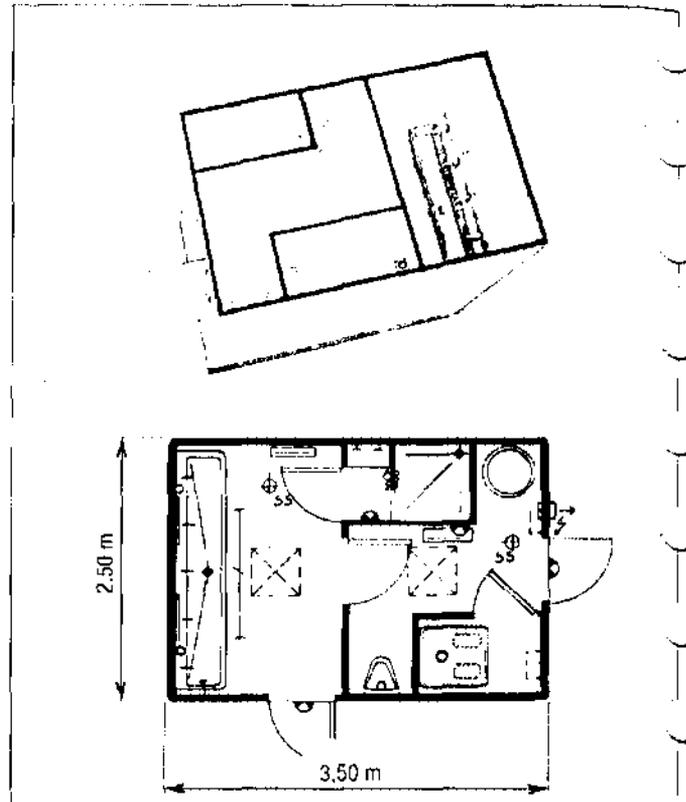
Modules sanitaires de chantier tout en panneaux sandwich en polyester armé de fibres de verre, totalement moulés intérieurement et extérieurement (1 douche, 1 WC, 1 urinoir, 5 points d'eau avec robinetterie mélangeuse) (extrait de la documentation JCR Équipements).
